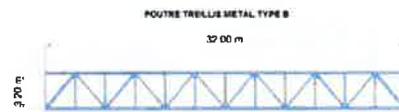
Poutre treillis niveau haut R+2 de l'Auditorium
